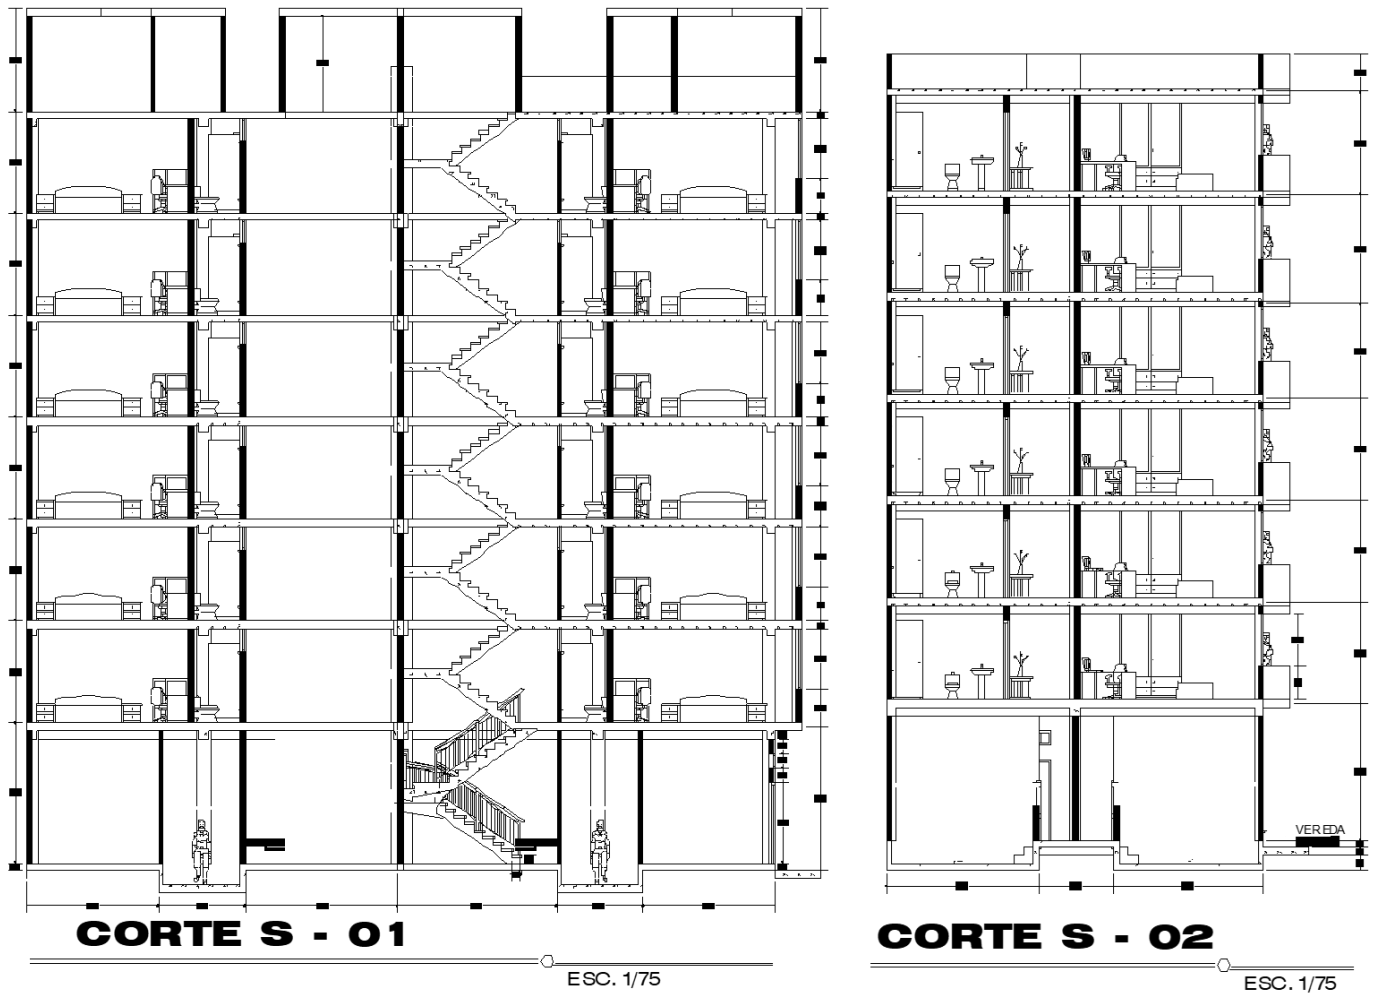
2: PLANOS DE PLAN ELEVACIÓN Y CORTES.
